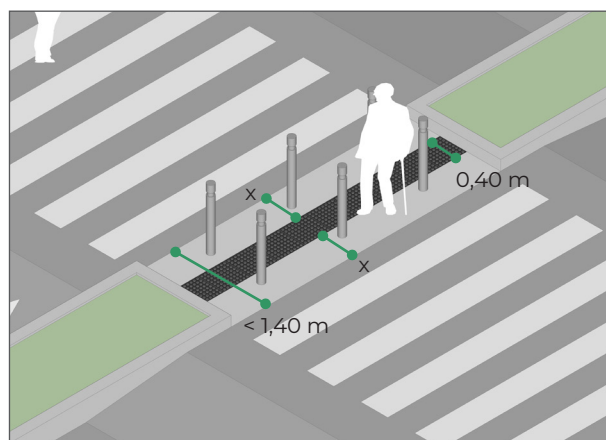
Piso podotátil em travessias entre pistas com largura inferior a 1,40 m.
